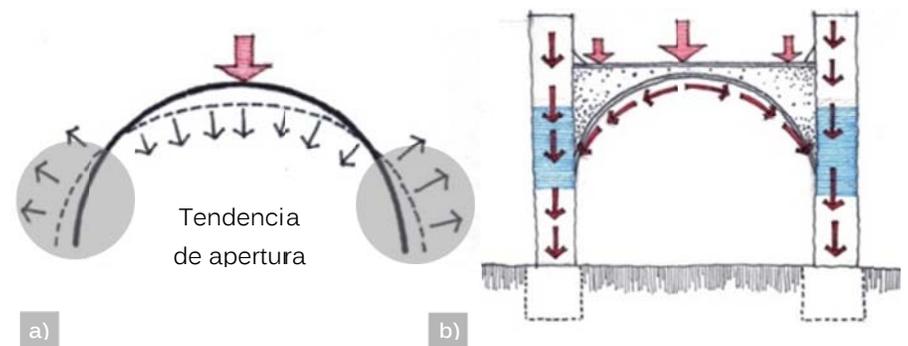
Esquema de Comportamiento estructural: a) arco y b) bajada de cargas del sistema constructivo del edificio.
